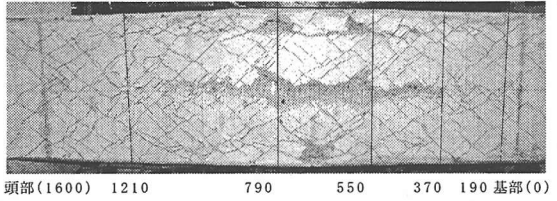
供試体の破壊位置 (No. 9 東面単位 mm)
